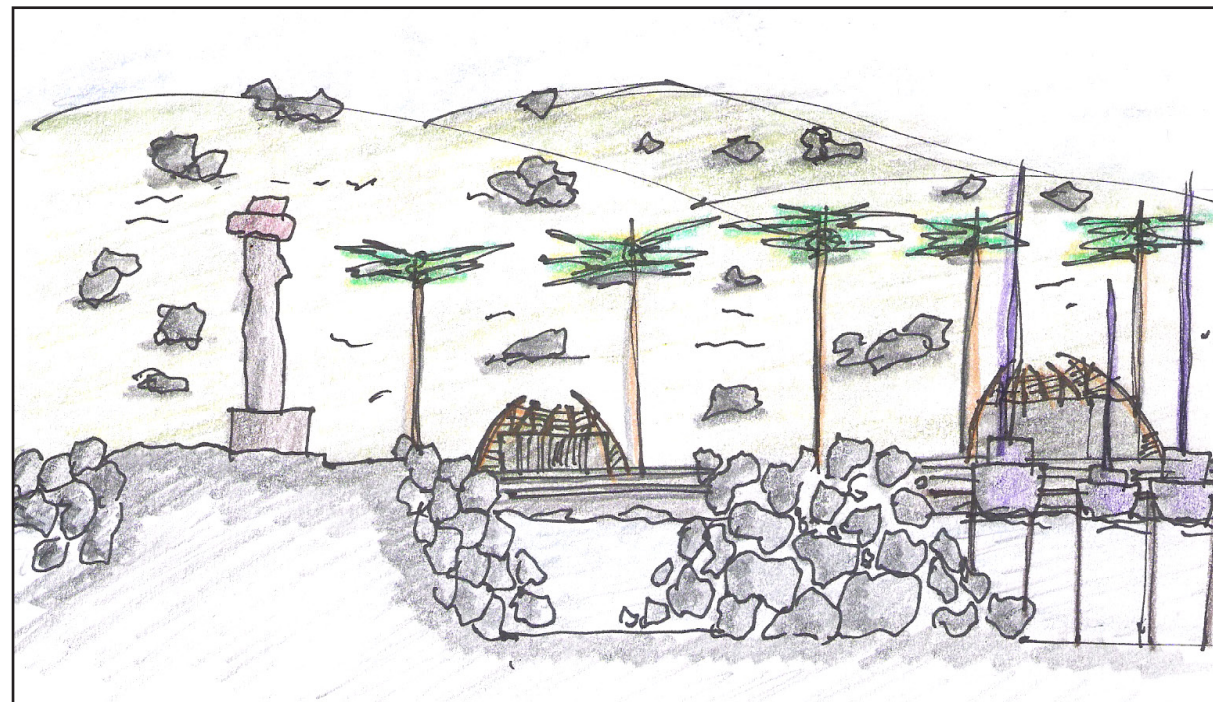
Croquis corte de la bahía.. Fuente: del Autor.
